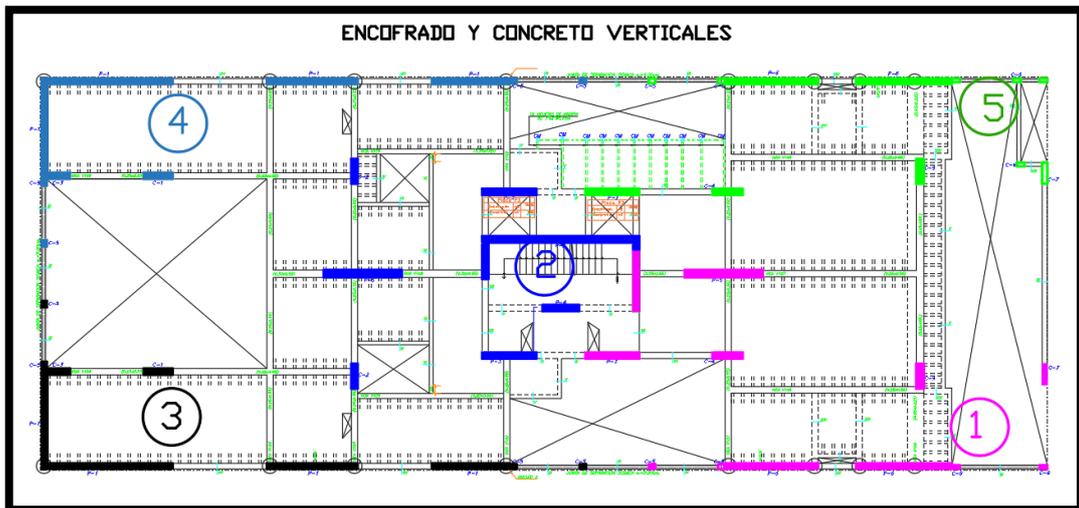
Sectorización de Elementos verticales para encofrado y vaciado de Concreto –Piso 1.
